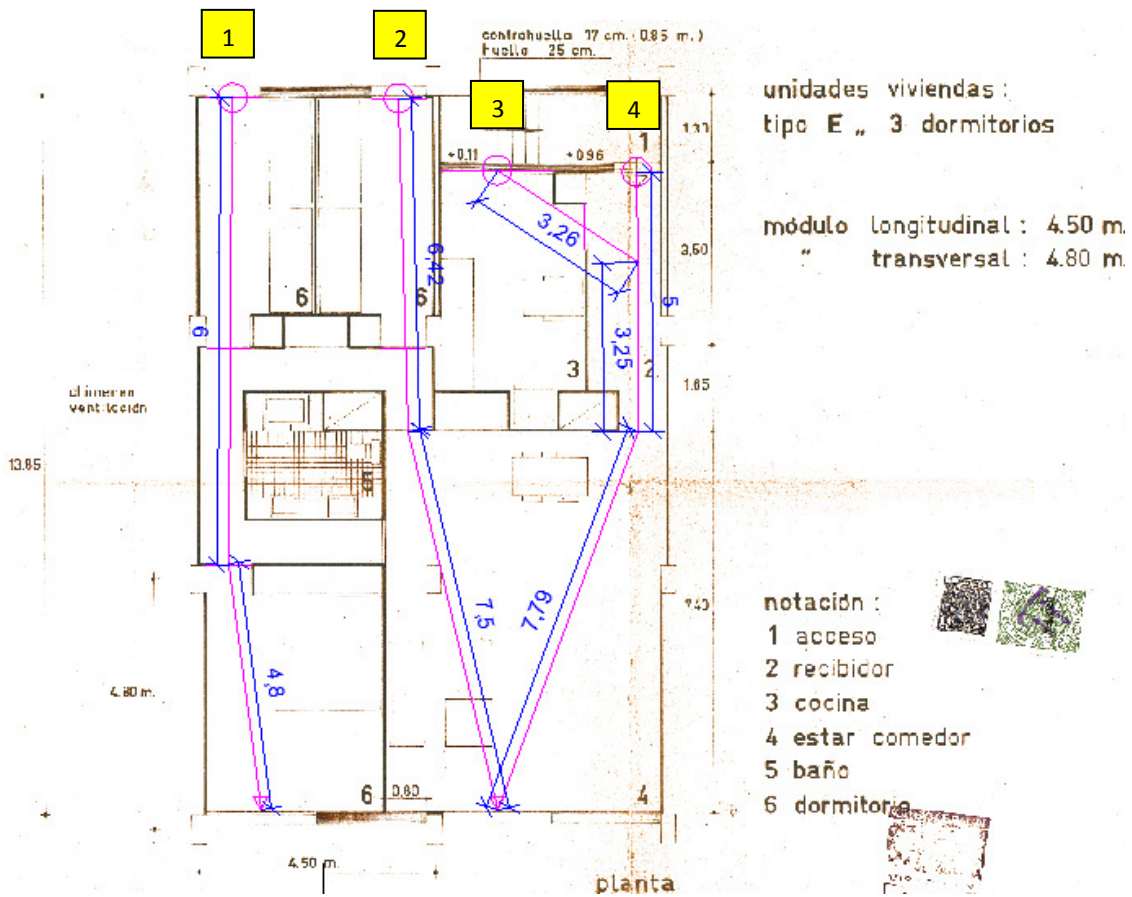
Recorridos del aire entre fachadas opuestas.
